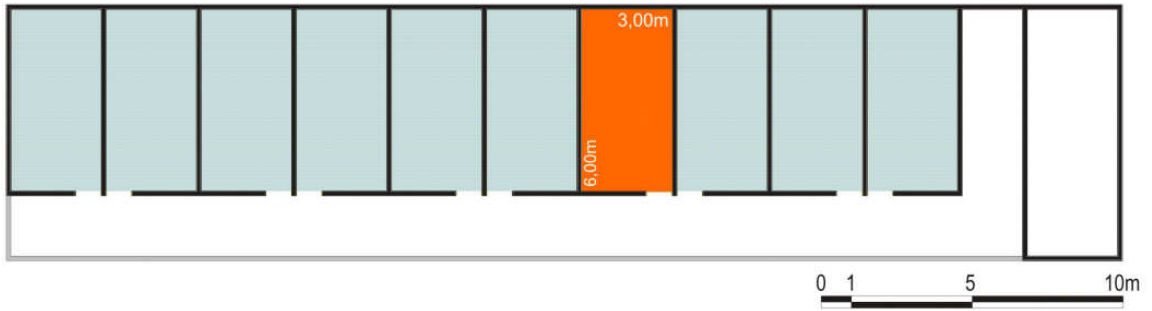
Planta baixa do caso base 1: corredor lateral.
